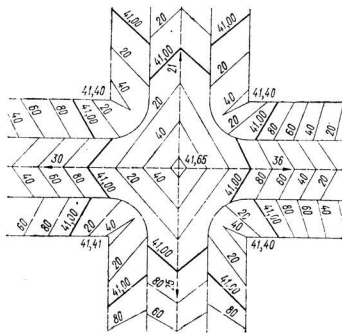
Вертикальная планировка перекрестка с размещением его на вершине холма.
